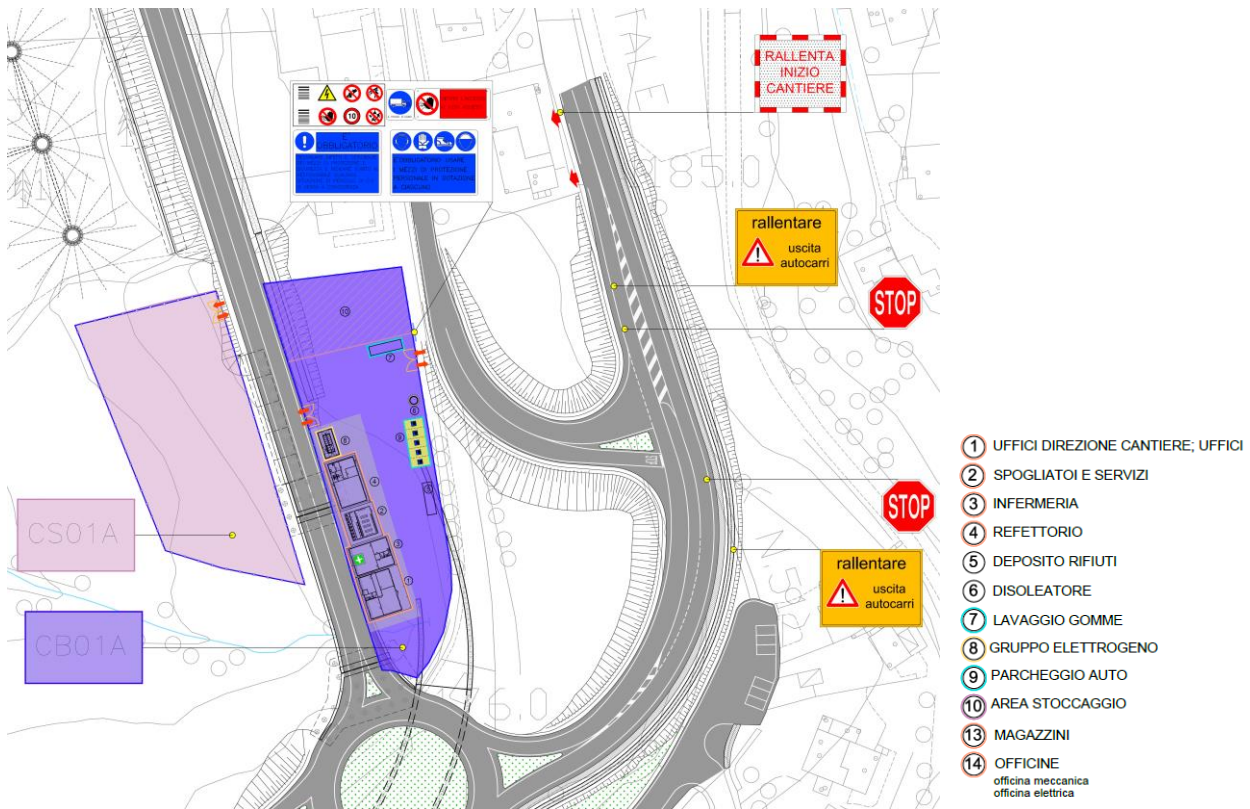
Planimetria Layout di cantiere - T01CA01CANPL05A
